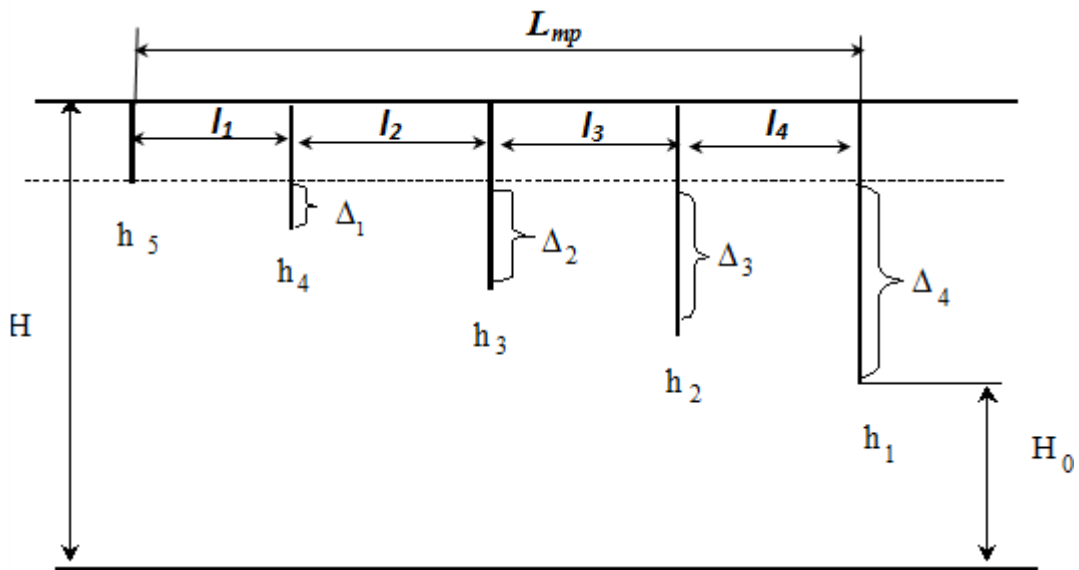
Схема розрахунку підвісок для кріплення трубопроводу
